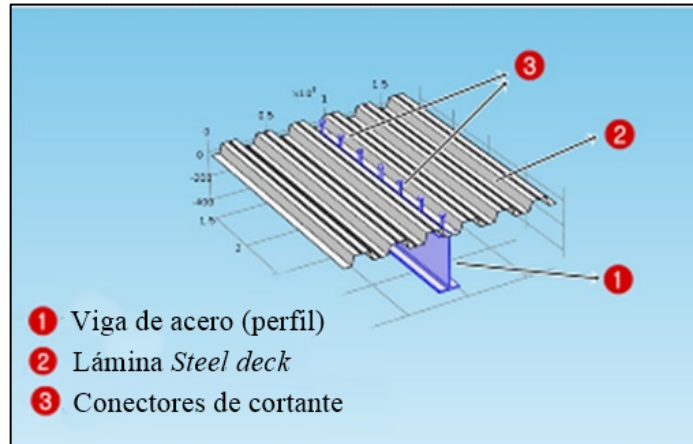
Sistema de losa en sección compuesta con nervios de la lámina paralelos al eje de la viga (antes de vaciar el concreto). Fuente: Autor
